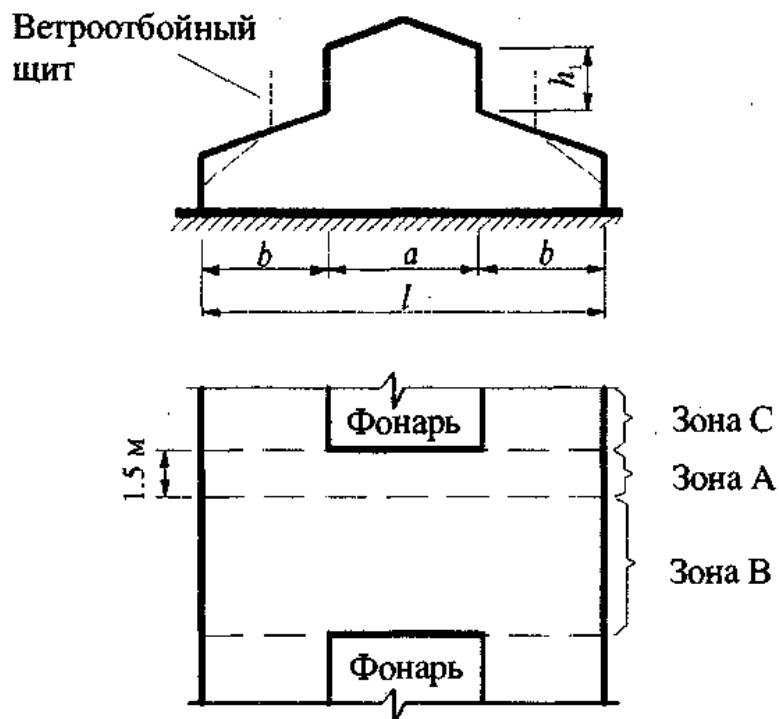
Снеговая нагрузка с продольными фонарями
